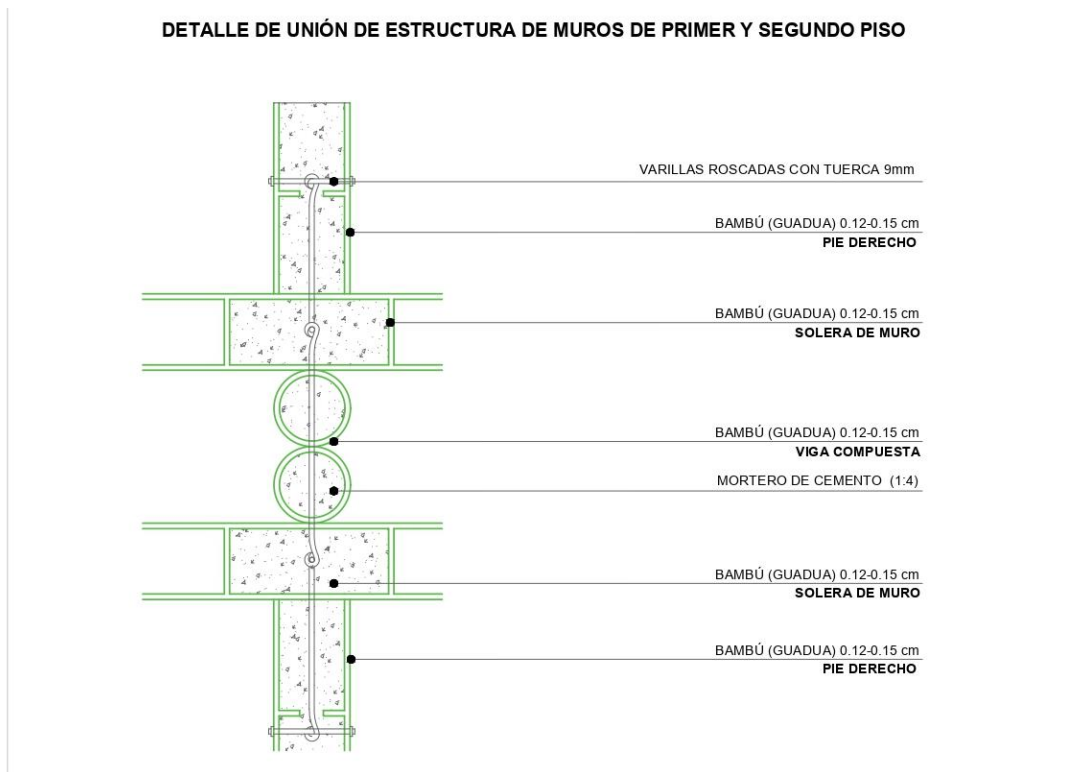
Detalle constructivo de unión entre solera, pie derecho en muros estructurales para entresijos. Fuente: El autor
